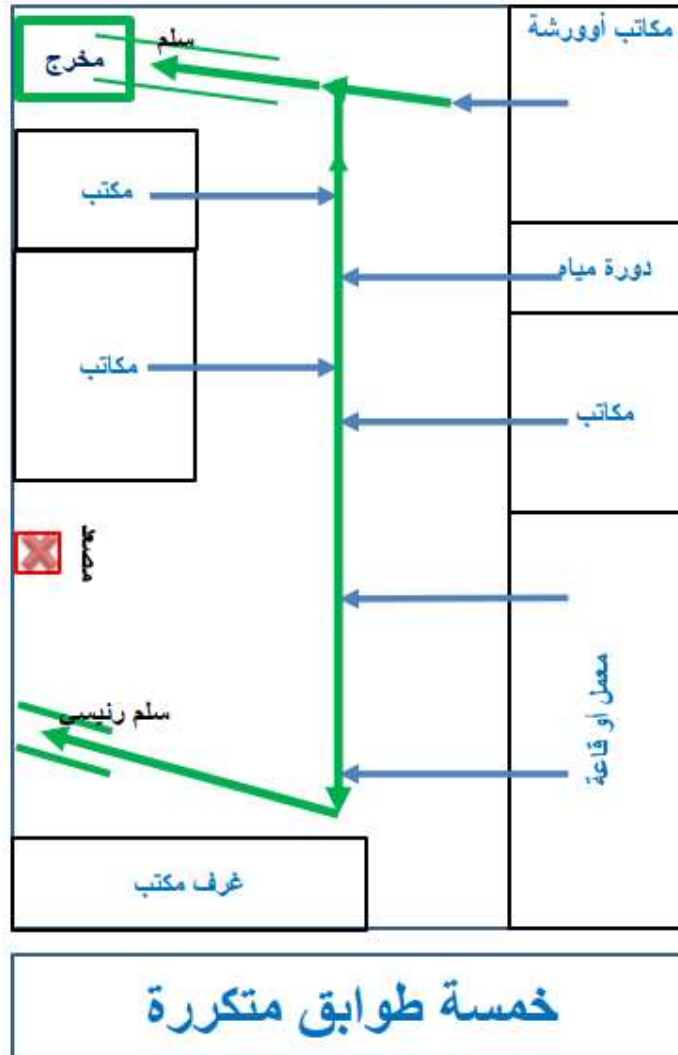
رسم تخطيطي للطابق الأرضي بمبنى مصطفى كامل
